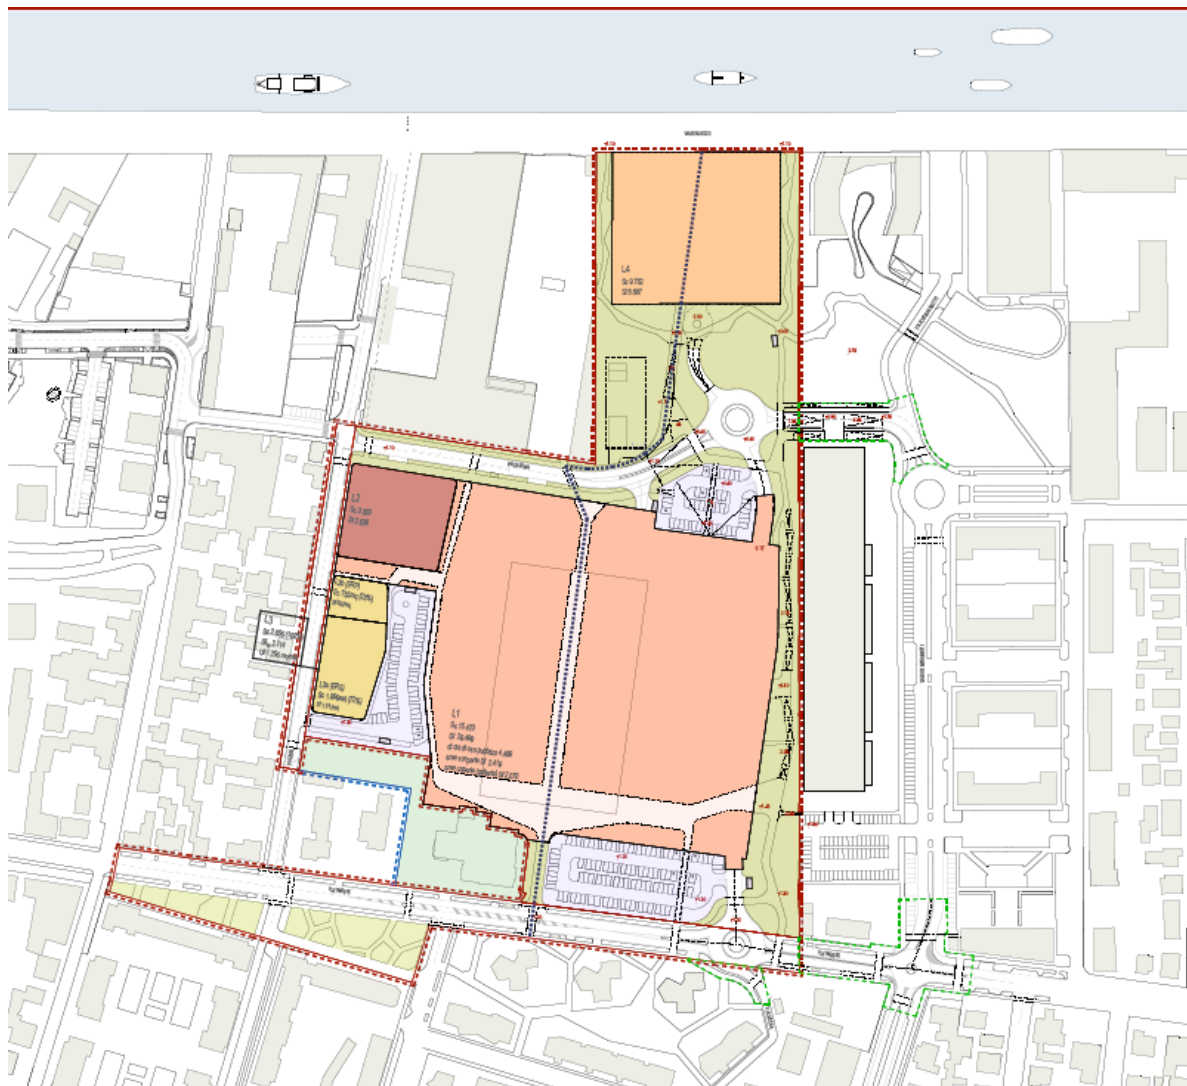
Planimetria estratta dalla tavola di PUA G.04_Prog.Zonizzazione_5
